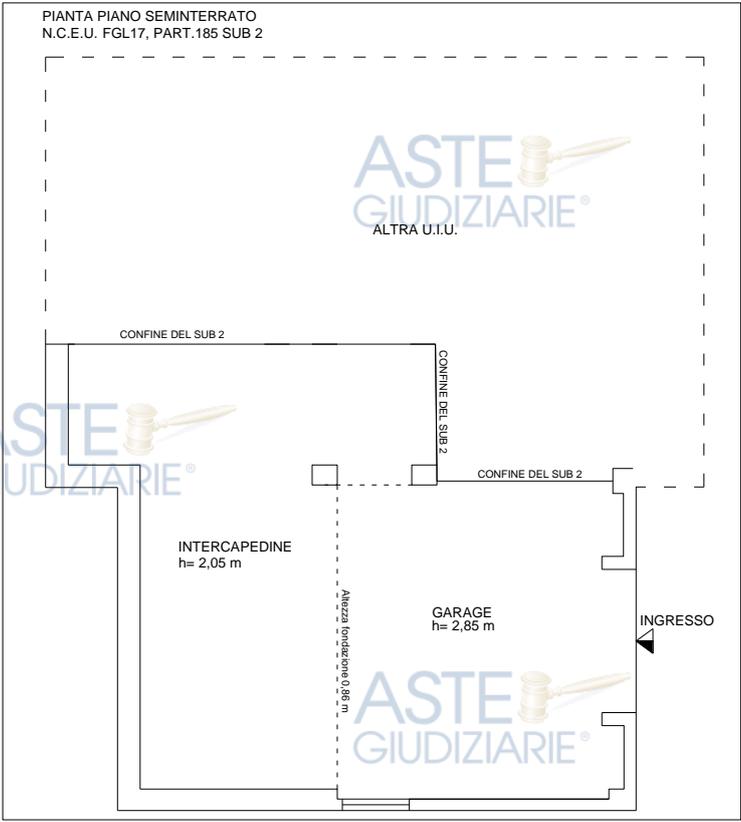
Pianta rilevata dell'immobile distinto al foglio 7/Part.185/Sub 2. Piano Seminterrato.
